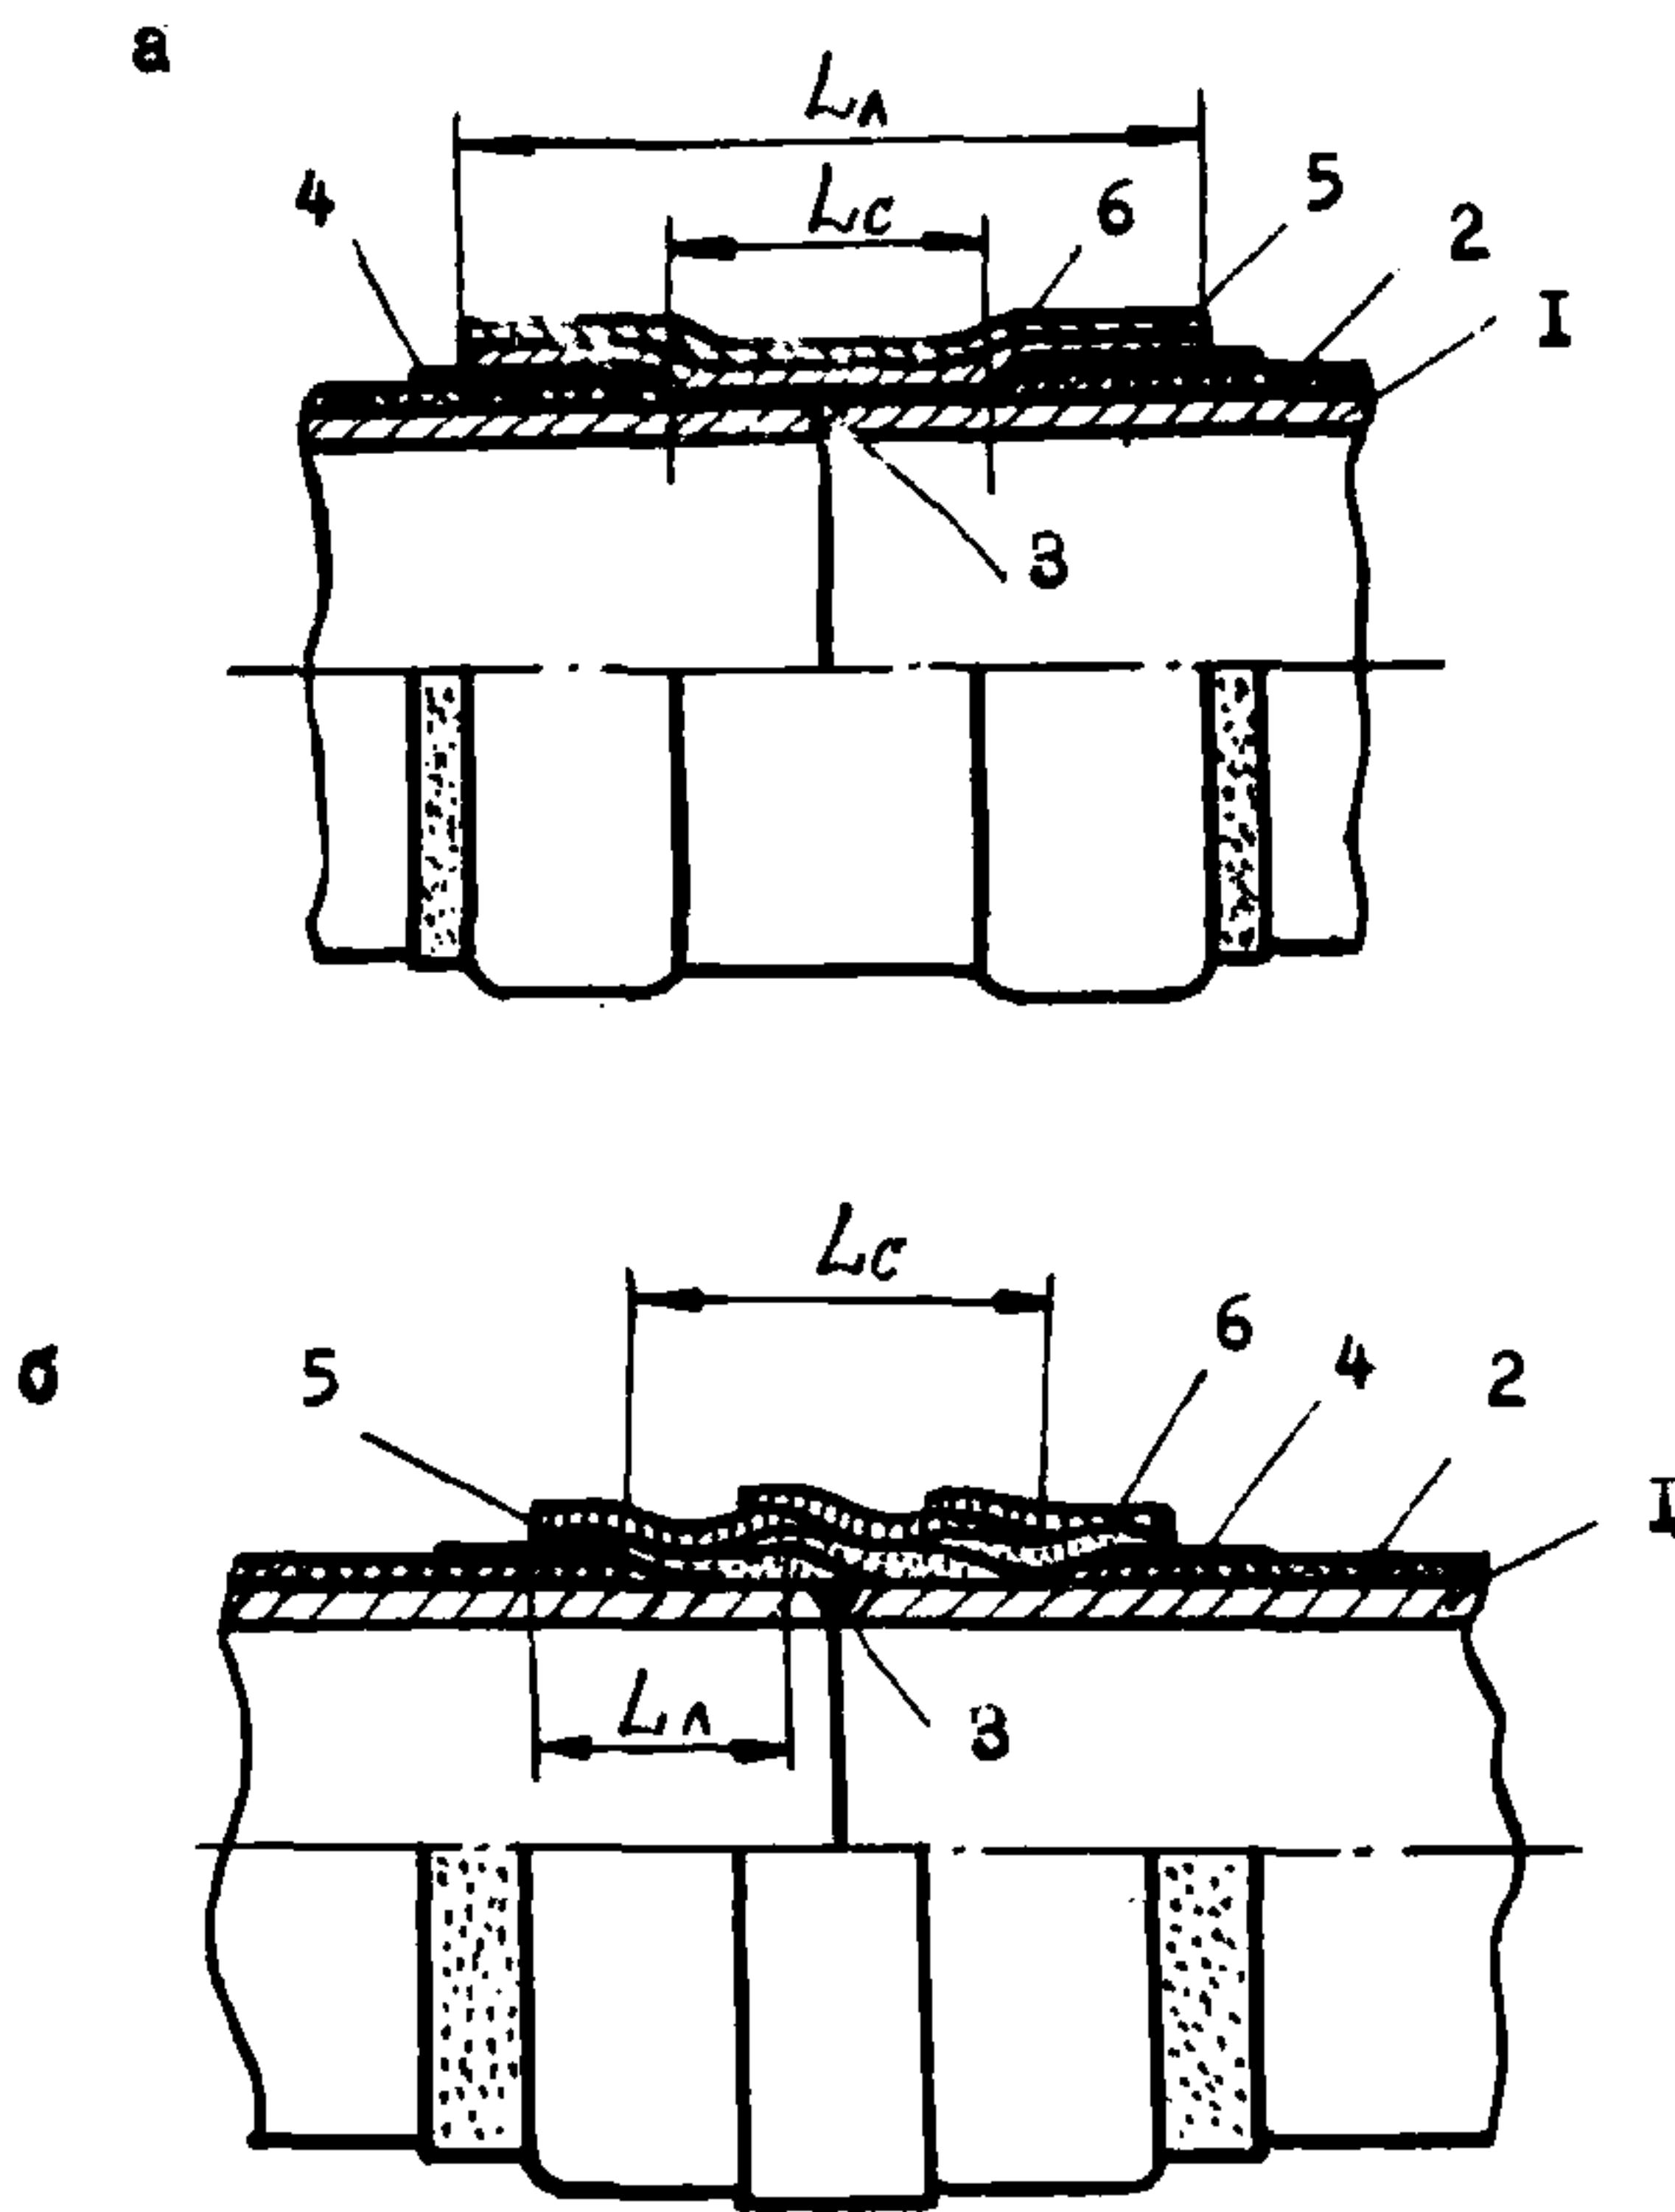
Изоляционное покрытие зоны сварного стыка полимерными лентами:
